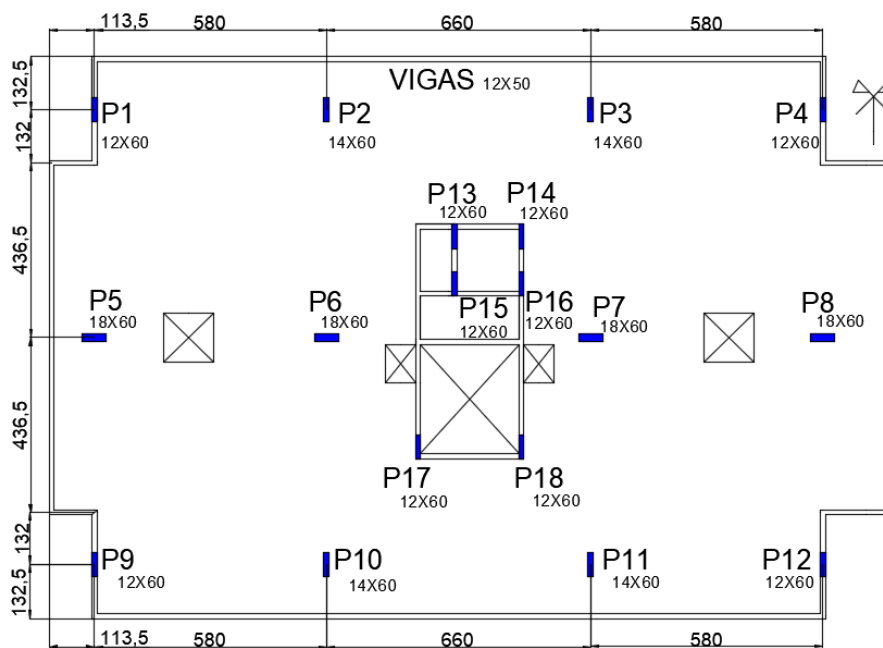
Planta baixa da estrutura – cotas em cm
